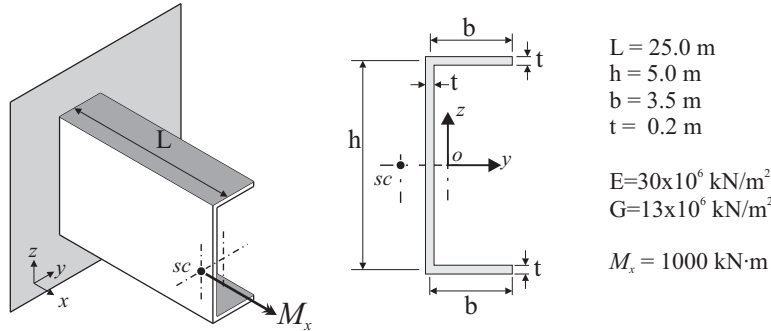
Geometría de una viga con sección C sometida a un momento torsor.
